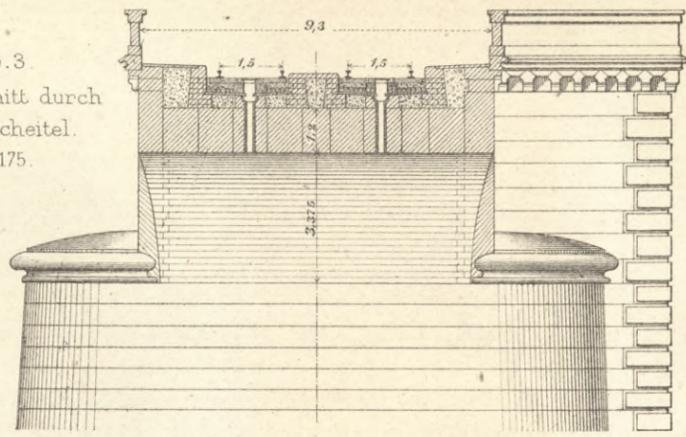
Entwässerung der Nydeck-Brücke in Bern.
